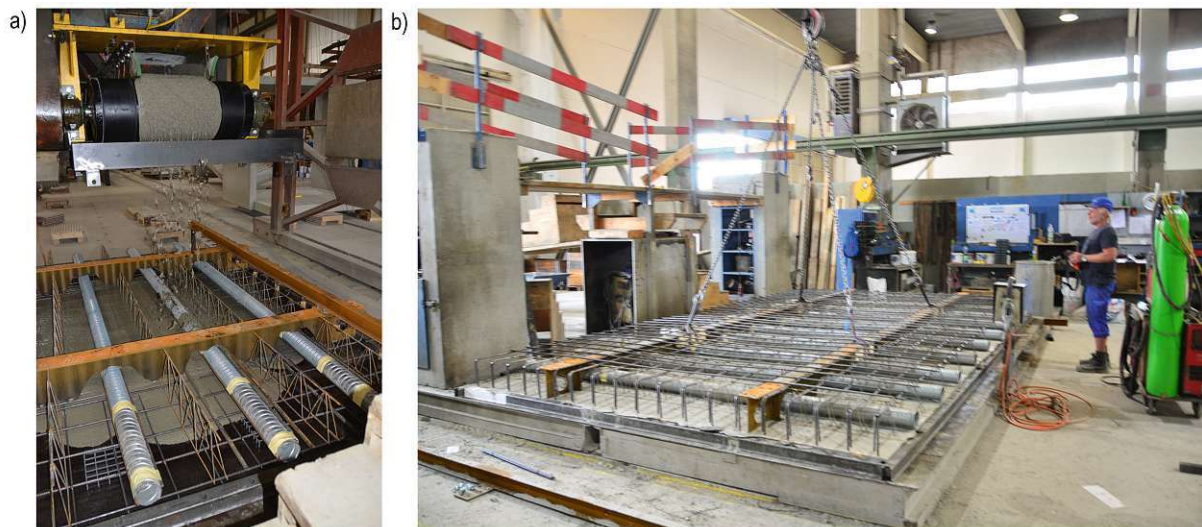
Halbfertigteil-Segmentbauweise: Herstellung dünnwandiger Platten im Werk a) Betonieren eines Halbfertigteils: integrierter Stahlträger mit Ausnehmungen für Hüllrohre; b) Fertiges Element bereit für den Transport zur Baustelle ©Stephan Fasching
